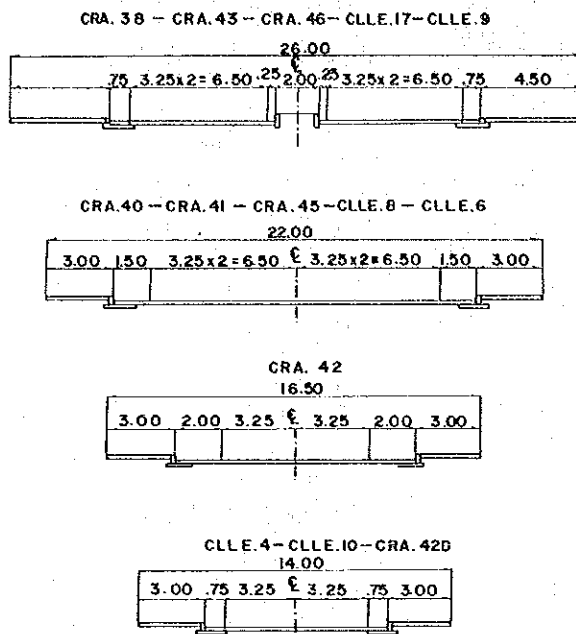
SECCION TIPICA DE LAS VIAS PLANEADAS
